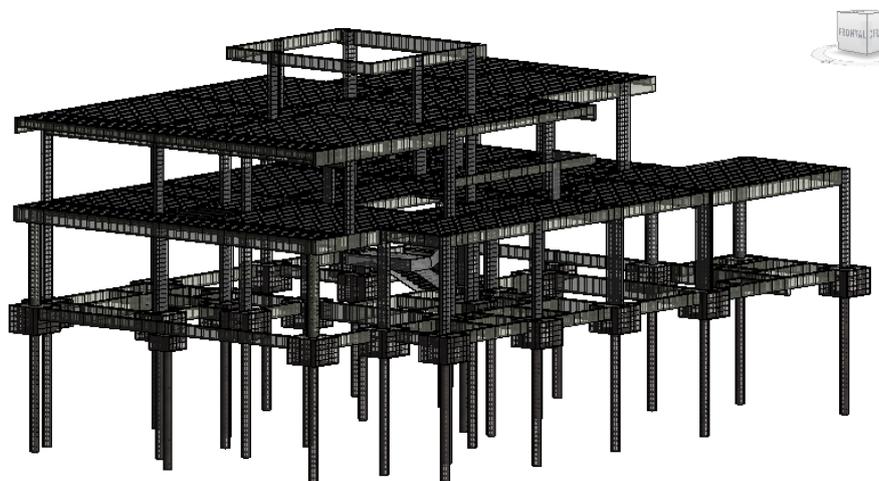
Elementos Estruturais do Projeto Incluindo Armação
